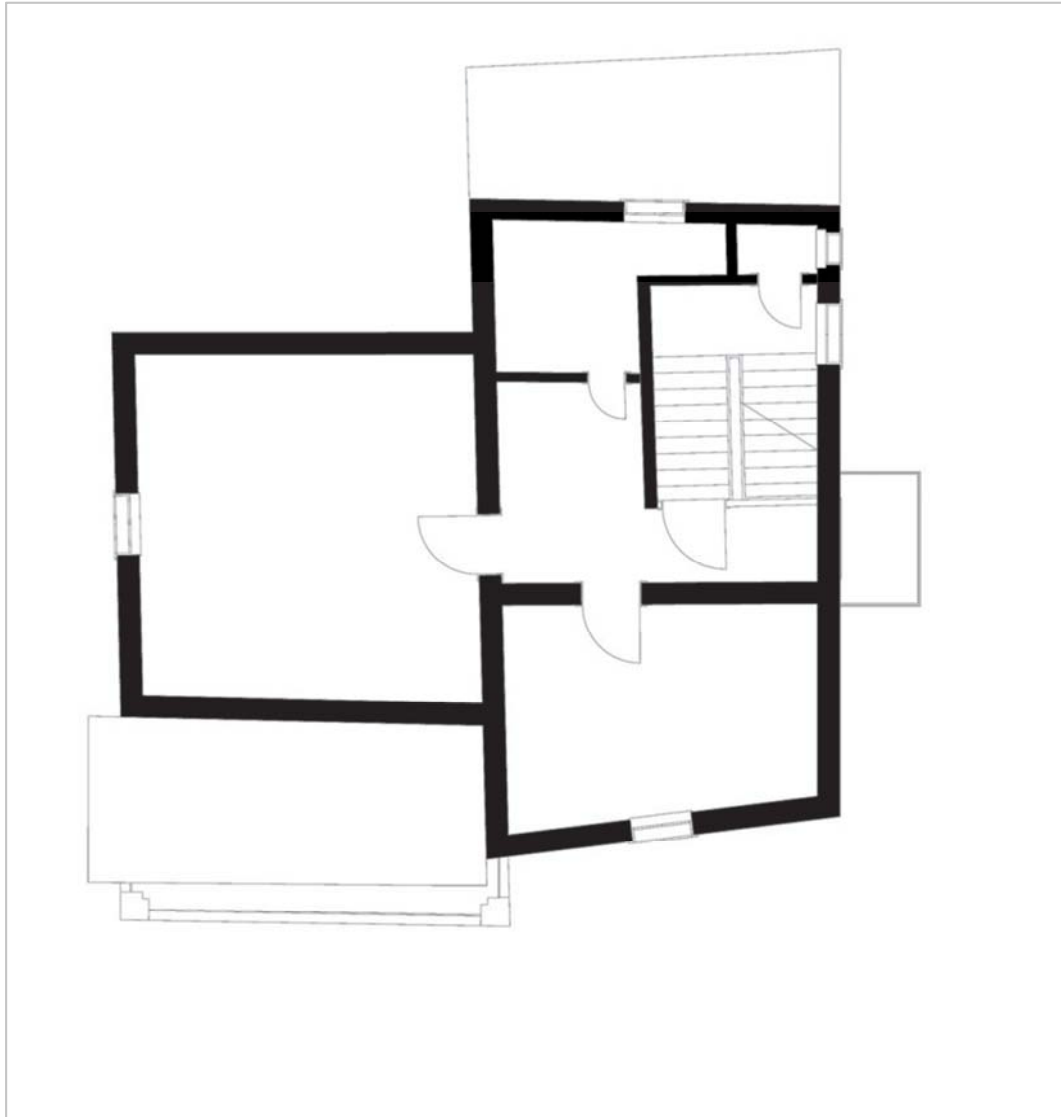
Grundriss des zweiten Obergeschoßes, 2017
